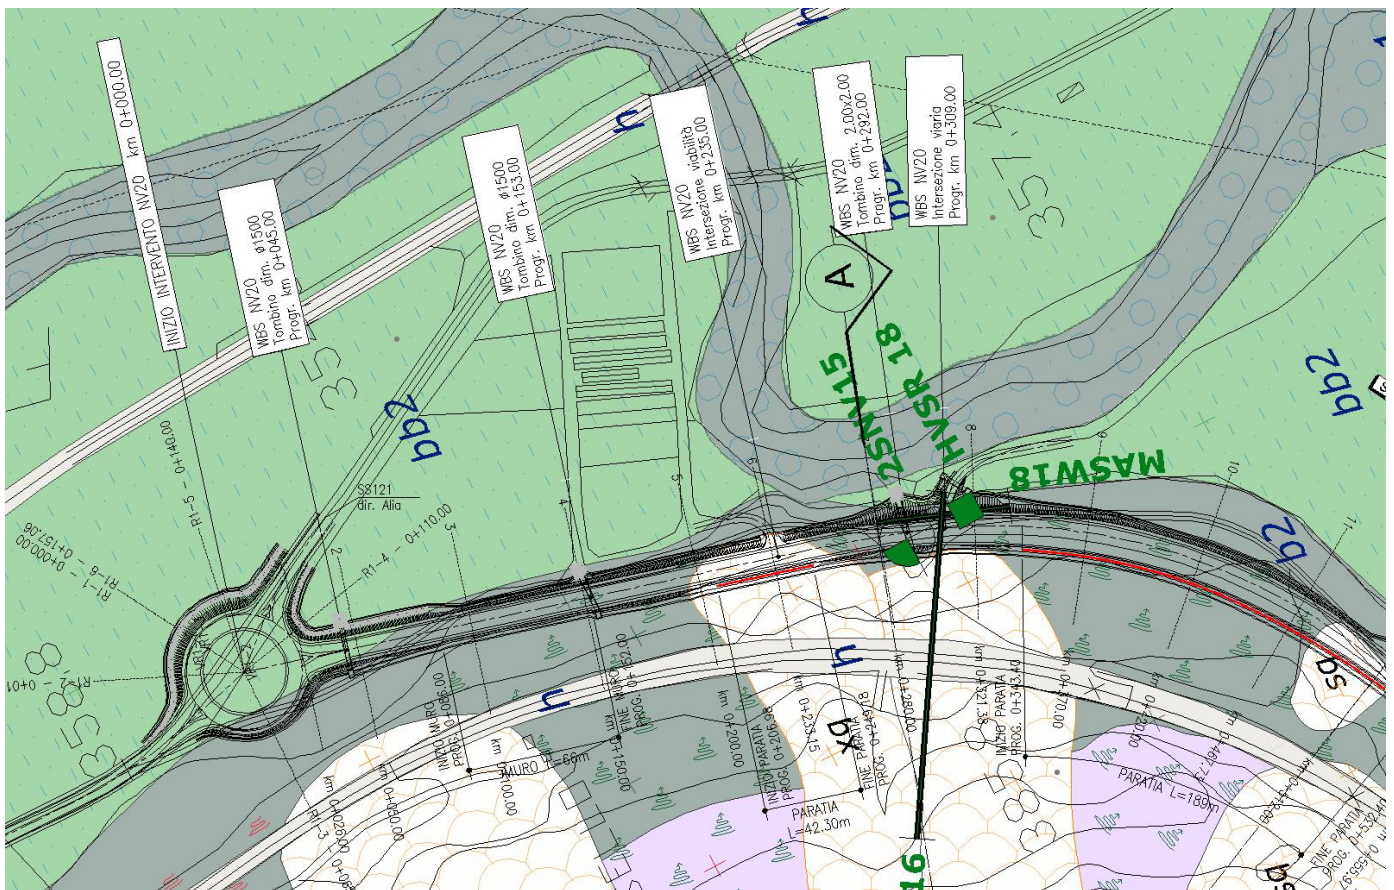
STRALCIO PLANIMETRICO DELL'OPERA IN PROGETTO
